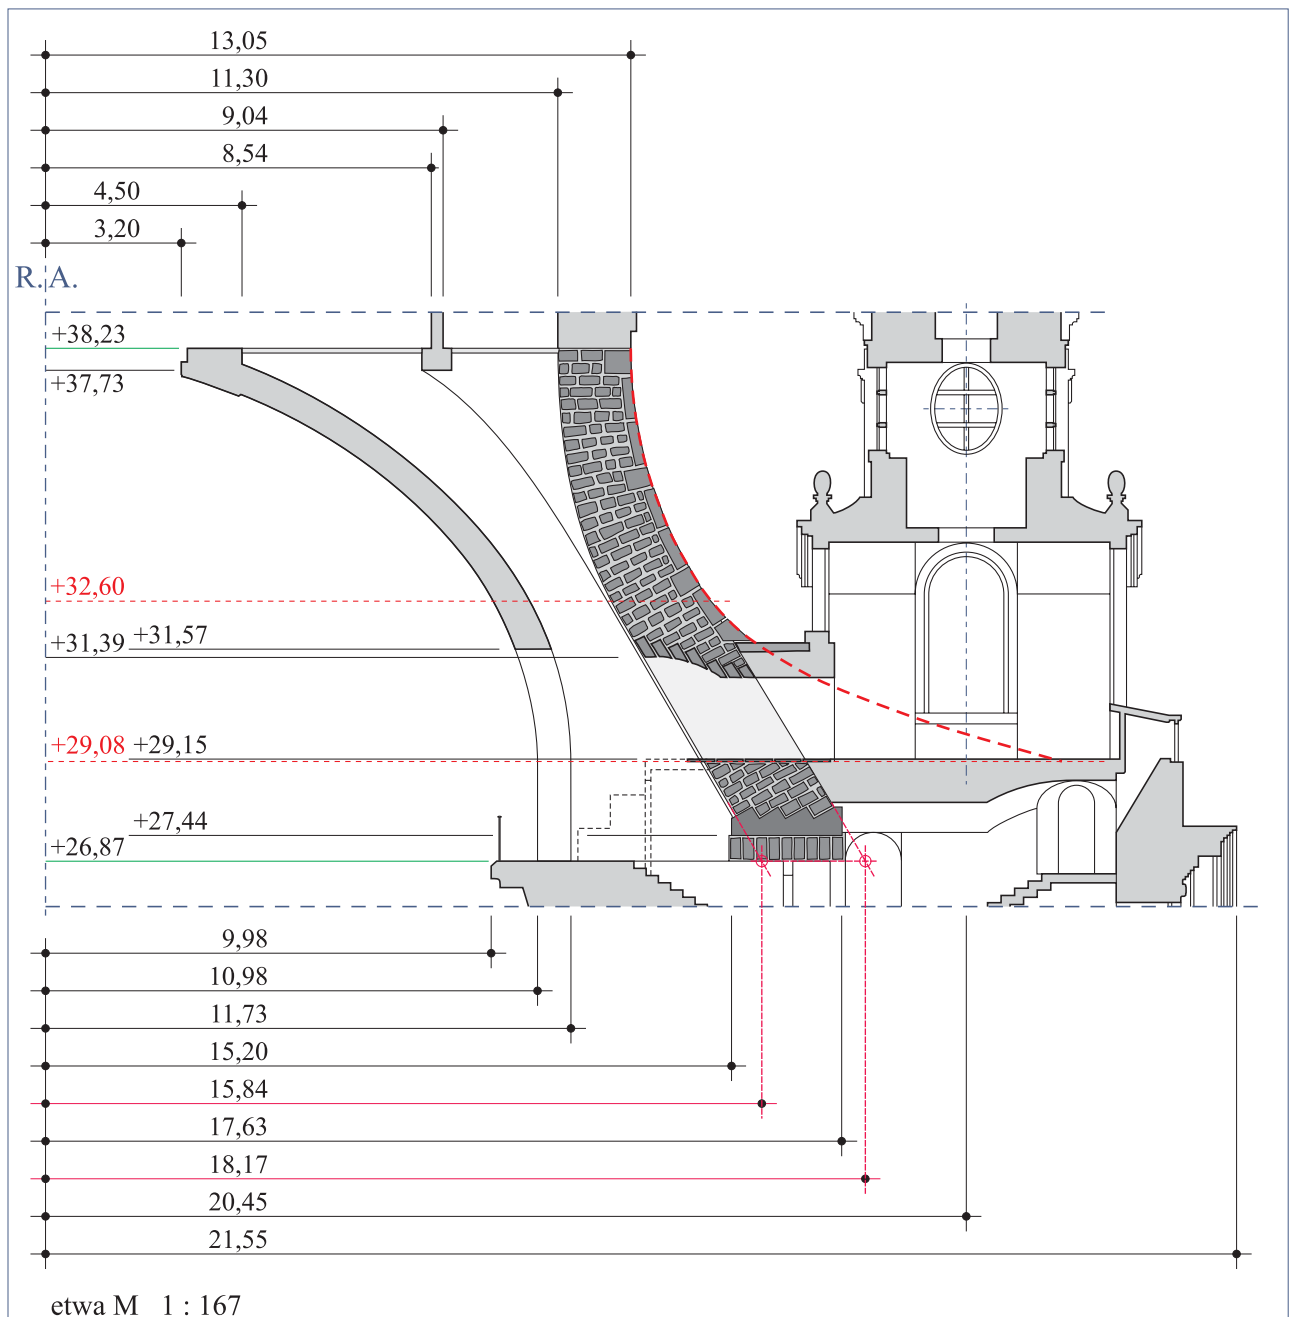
Geometrie des unteren Teils der tragenden steinernen Glocke.
